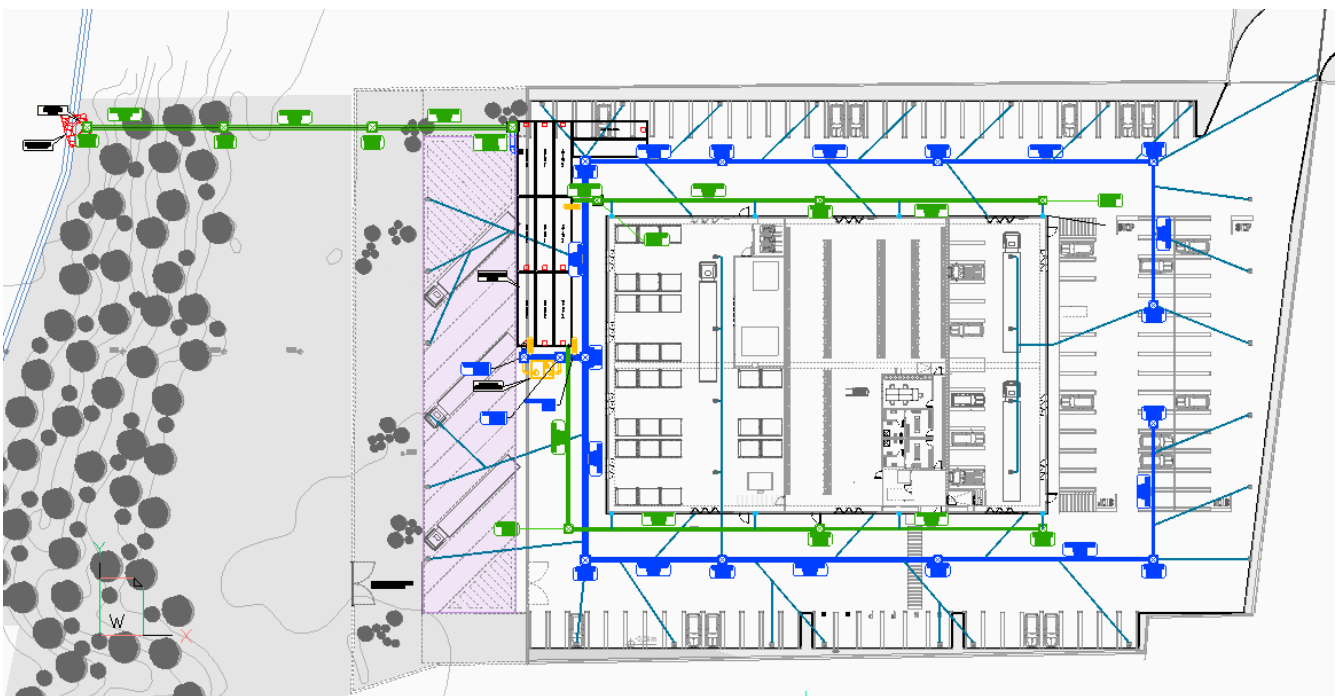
Stralcio planimetria di progetto opere idrauliche
